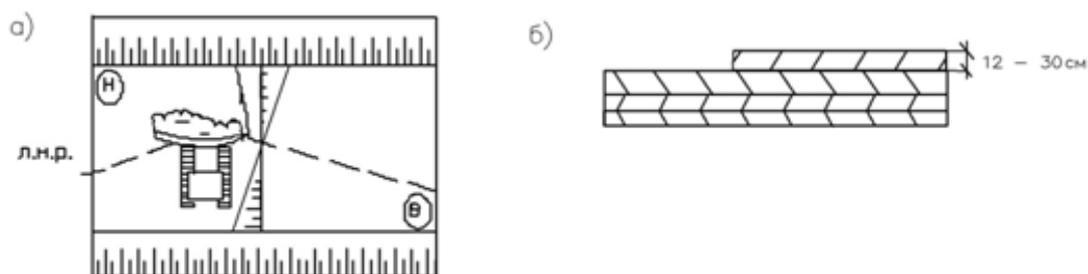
Послойный способ разработки грунта бульдозером:
